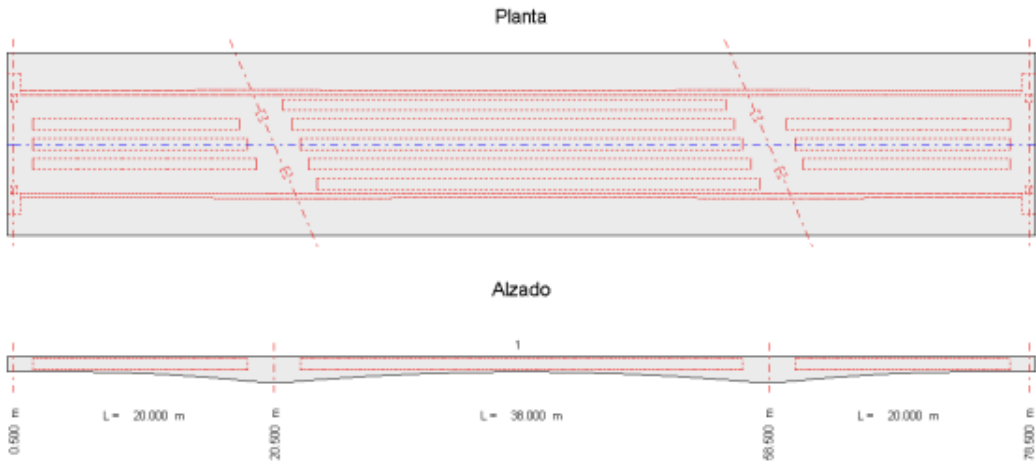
Modelo de cálculo realizado con CivileStudio de la losa aligerada. Pasos superiores con ancho de 14,0 m
